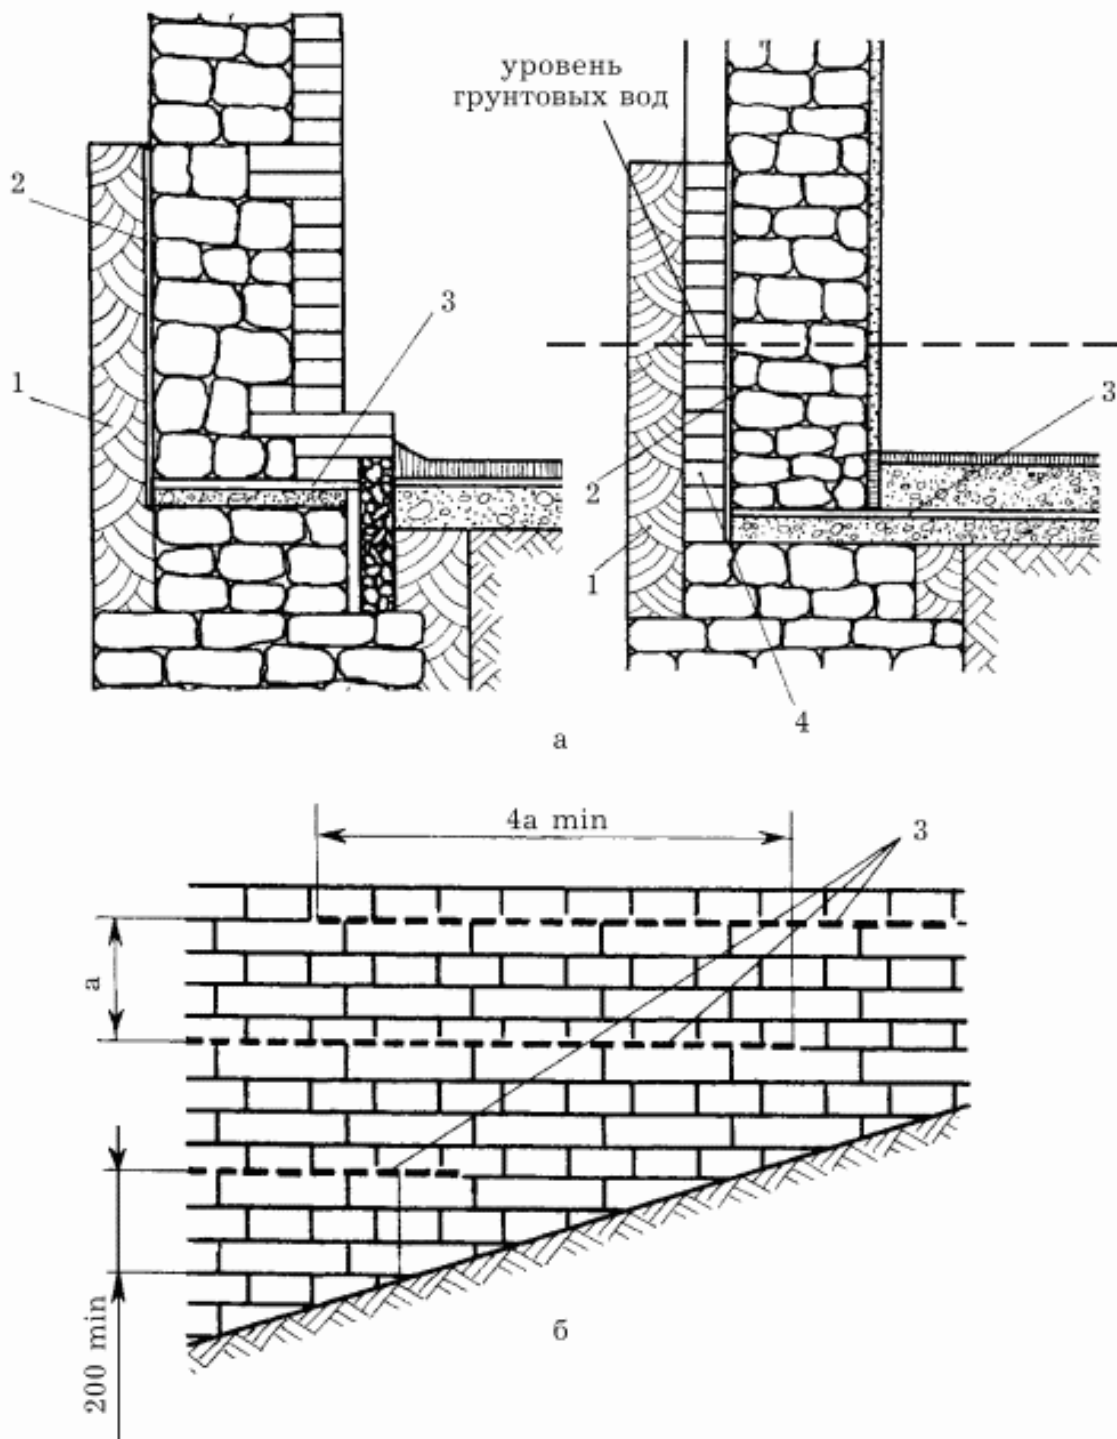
Гидроизоляция фундаментов: а – вертикальная; б – горизонтальная; 1 – глиняный замок; 2 – оклеечная изоляция; 3 – горизонтальная изоляция; 4 – прижимная стенка.
